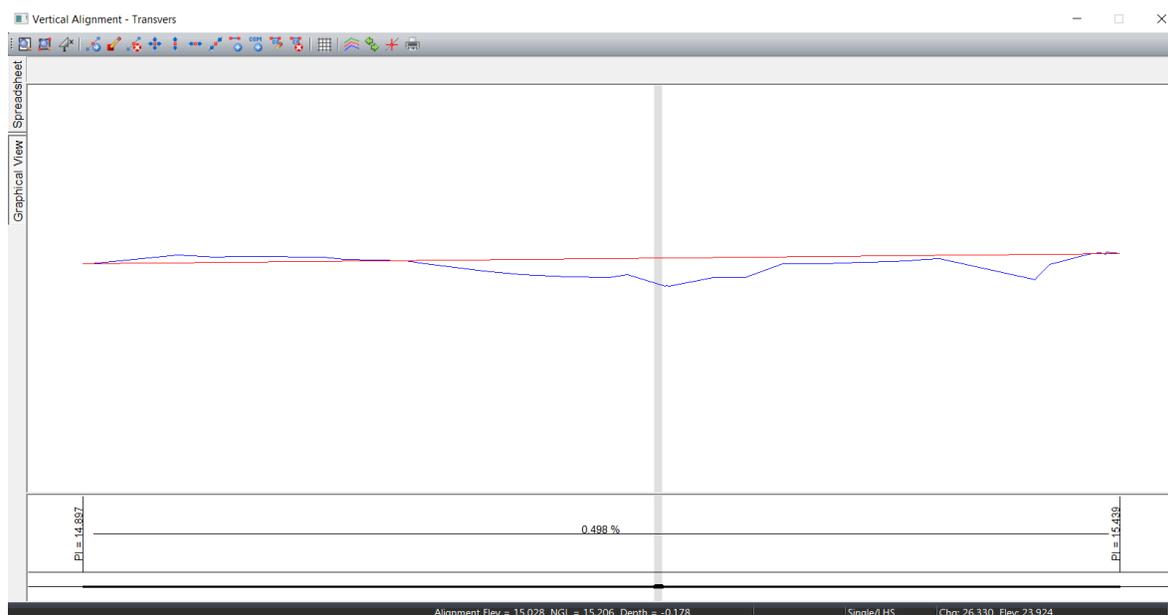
Ventana emergente, alineamiento vertical previo calle transversal.
